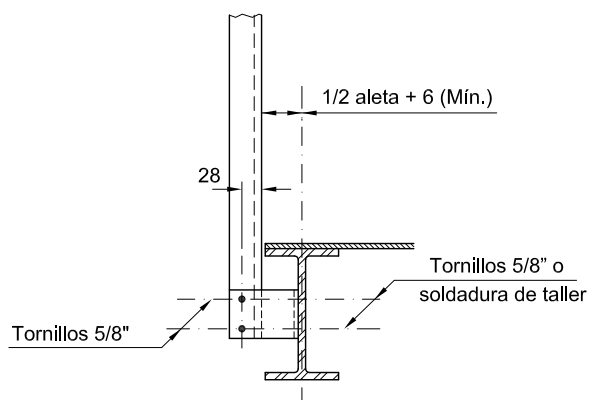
Barantilla Típica en Viga U con Protección Contra Fuego
